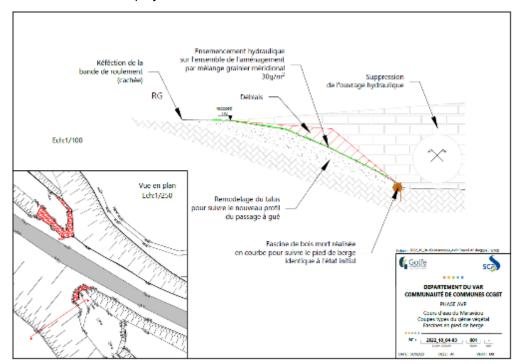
coupe type stabilisation pied de berge avec fascine morte (exemple de photo à droite)
